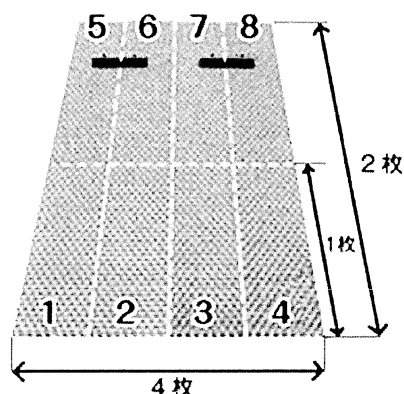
ターフパーキングの施工図 (乗用車1台分施工図)
